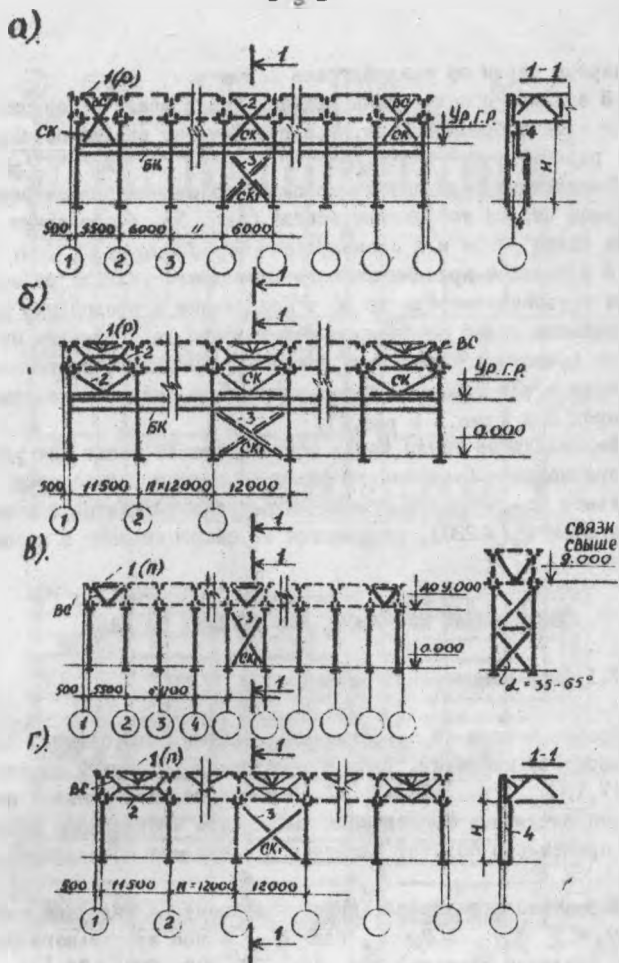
Схемы связей по колоннам с опорными мостовыми (а, б) и подвесными кранами (в, г)
